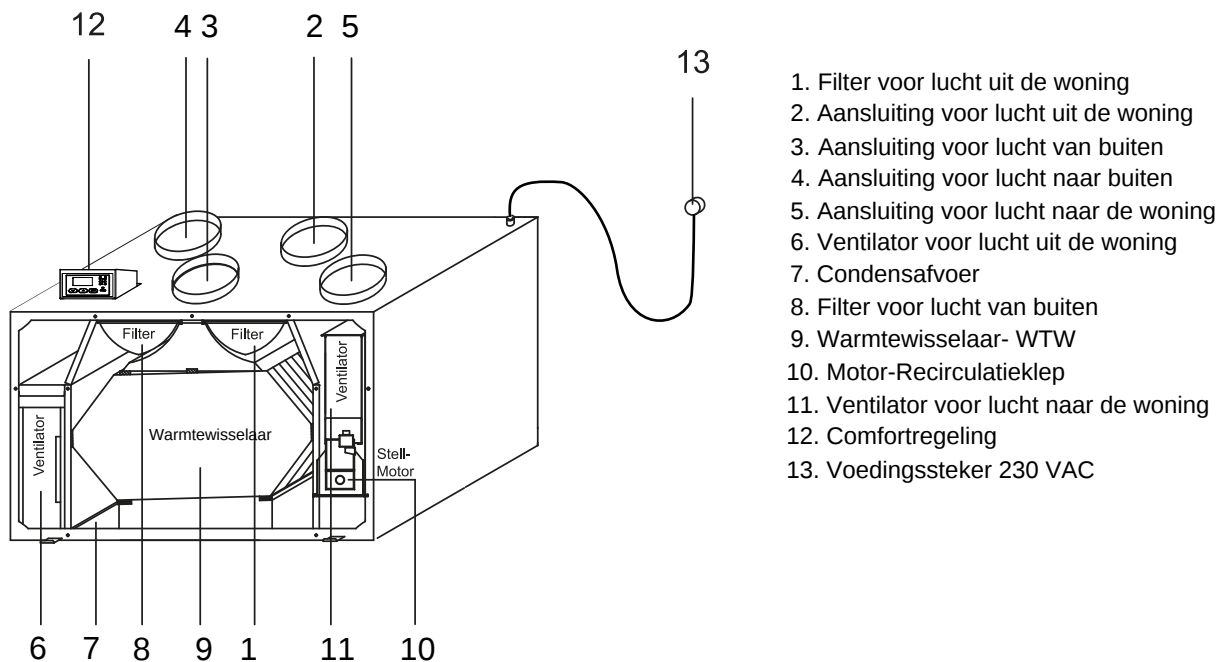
Voor- en bovenaanzicht EuroAir 480BY E6 (met bypass, rechtse uitvoering)
